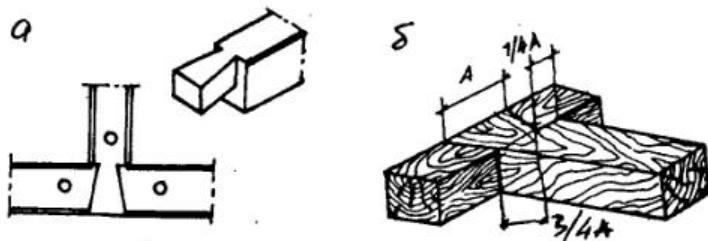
Крепление балок перекрытия в стенах: а — сковороднem; б — полусковороднem.
